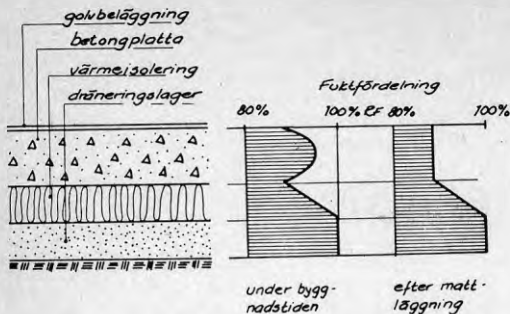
Golvkonstruktion och fuktfordelning vid betongplatta med underliggande värmeisolering.
